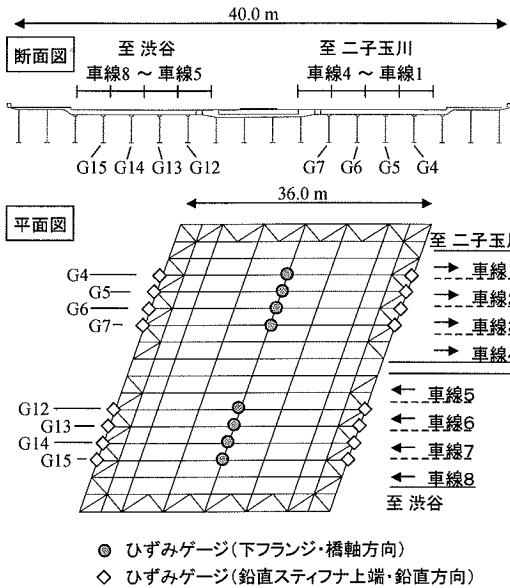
大坂橋の断面図・側面図とひずみゲージ位置
